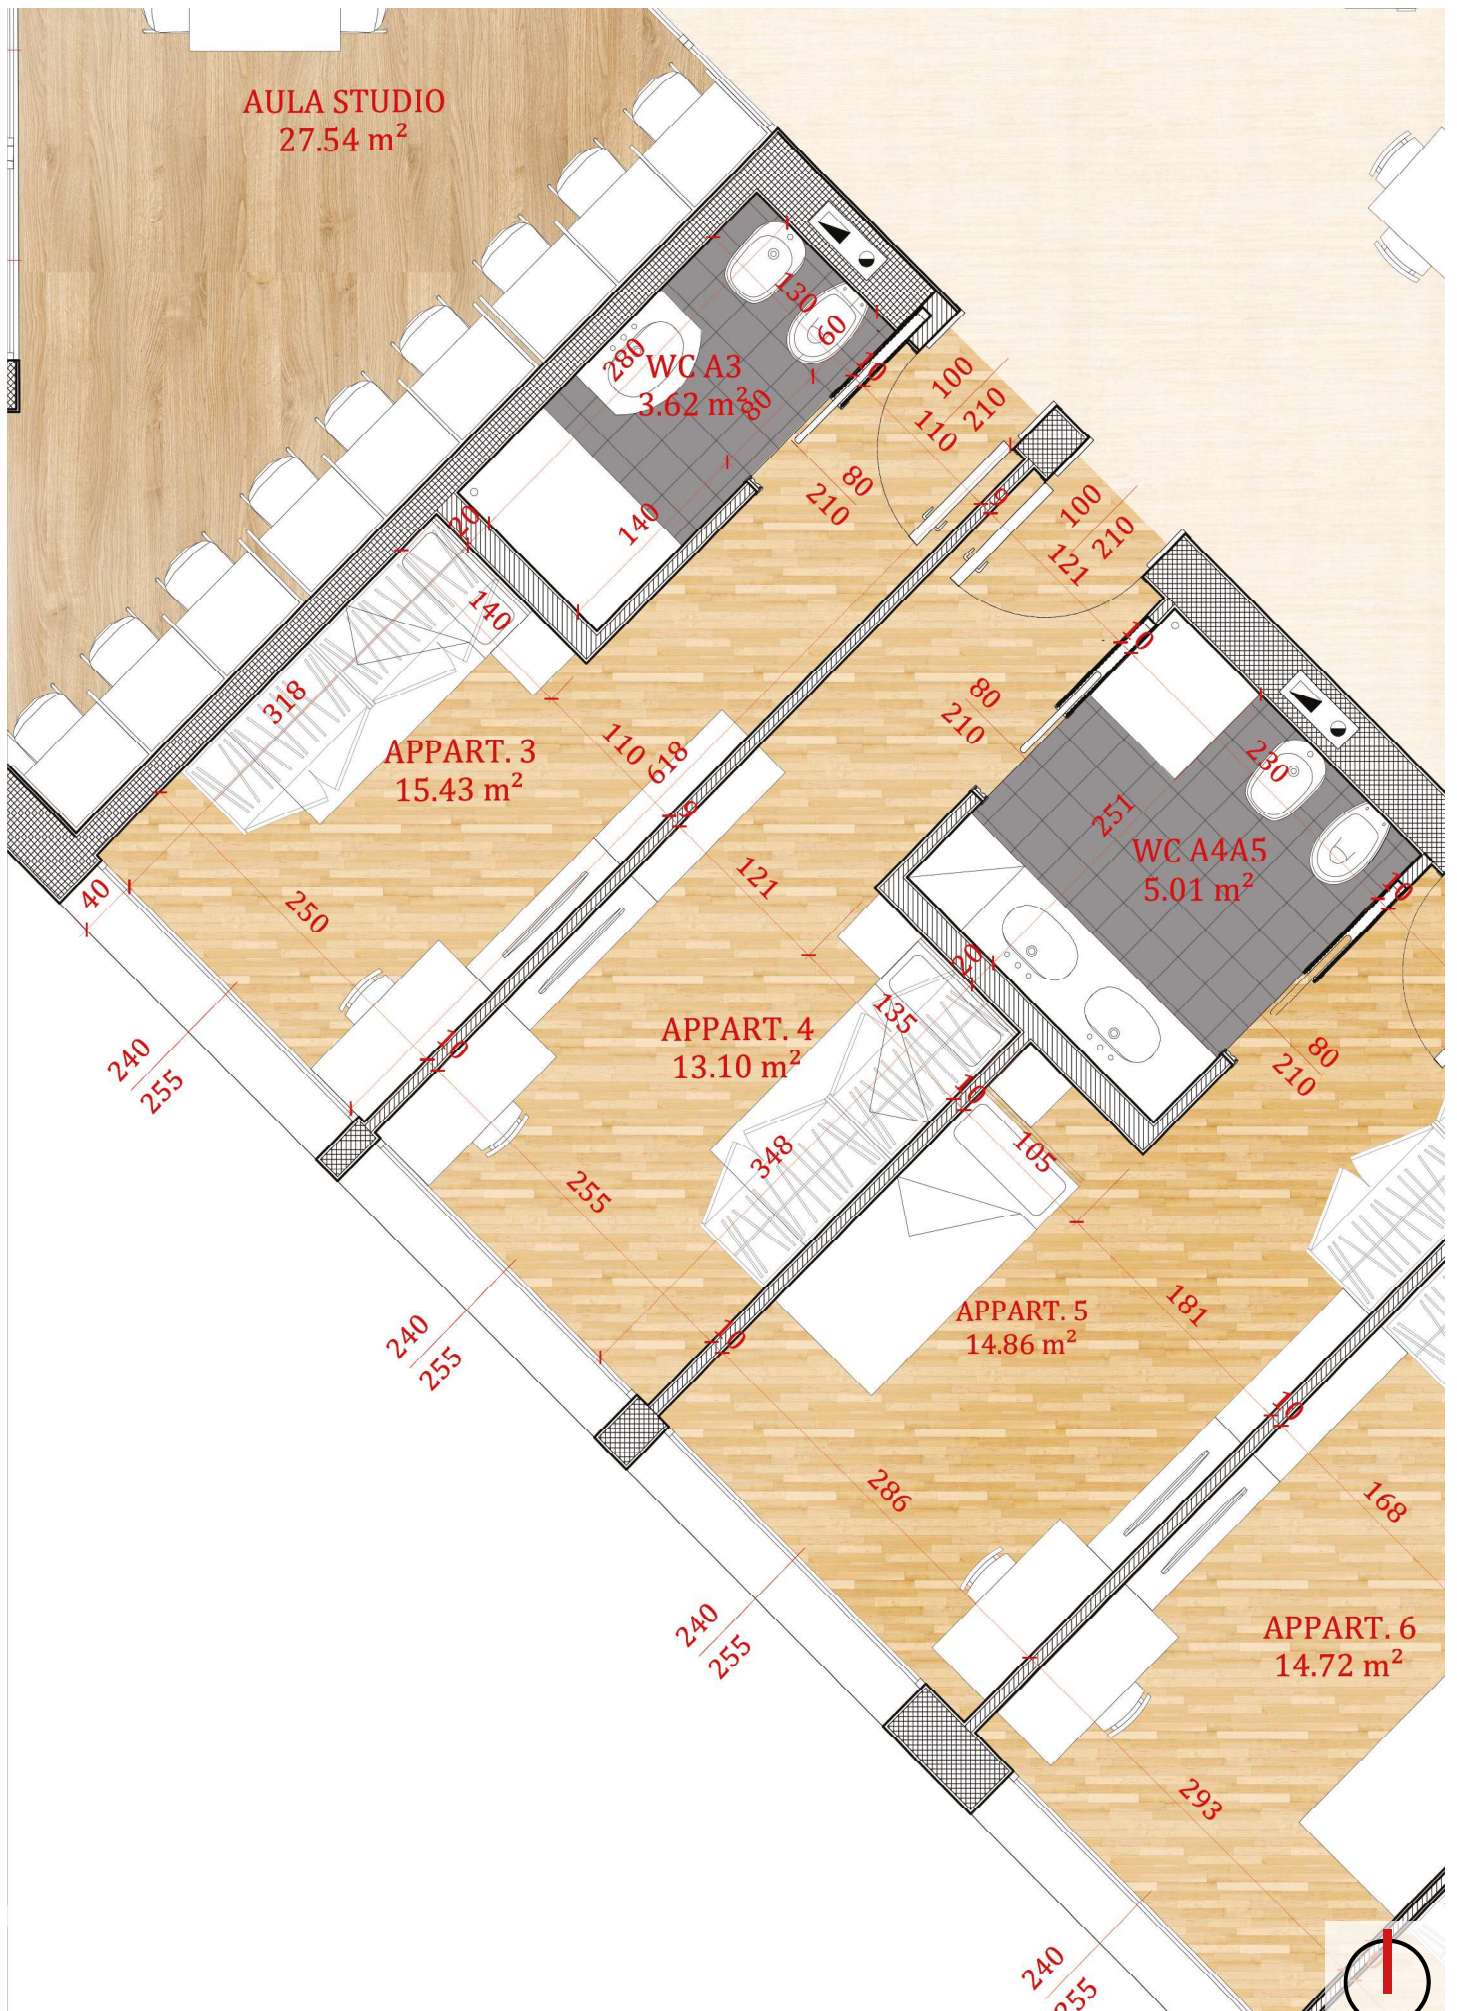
Particolare dalla pianta del piano tipo focalizzato su un alloggio 'ad albergo'
